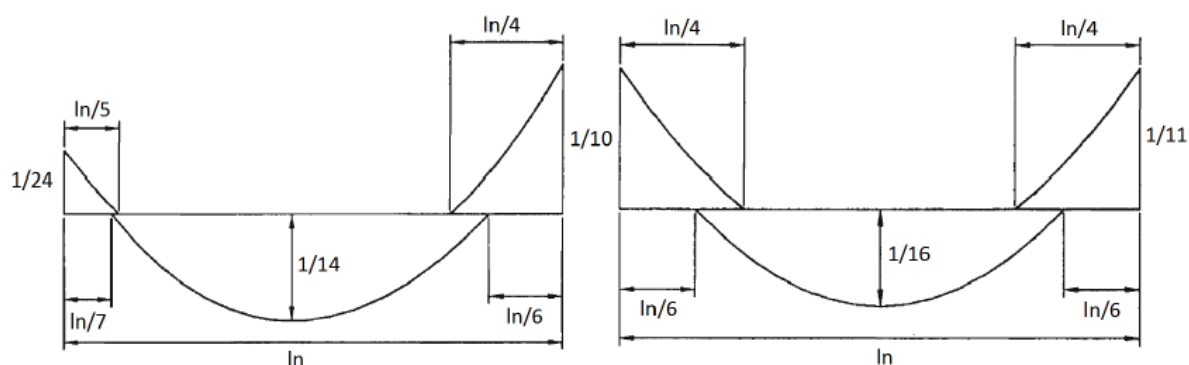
Corte del refuerzo en tramos exteriores e interiores de las viguetas.
